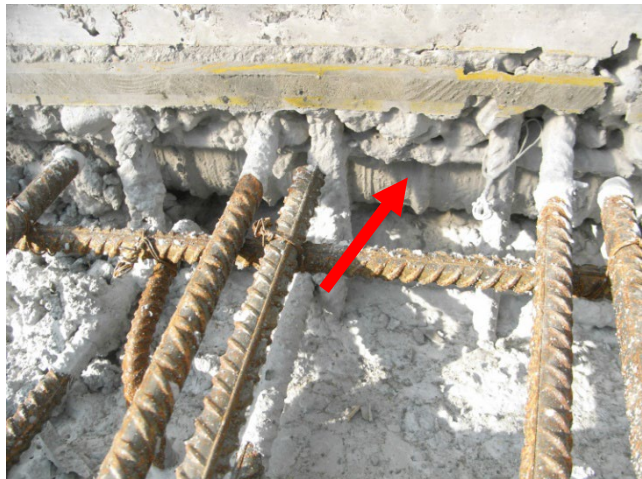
Hohlkasten einer Brücke nach dem Ausschalen [37]. Gut sichtbar ist das nicht einbetonierte Spannglied (roter Pfeil). Fotos F. Hunkeler.
